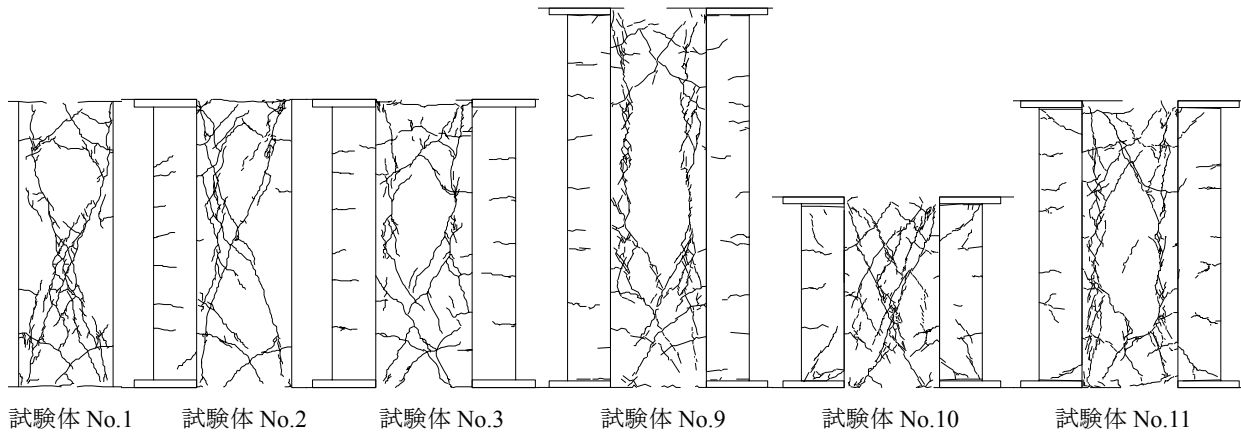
ひび割れ状況 ($R=1/100\text{rad}$.)
